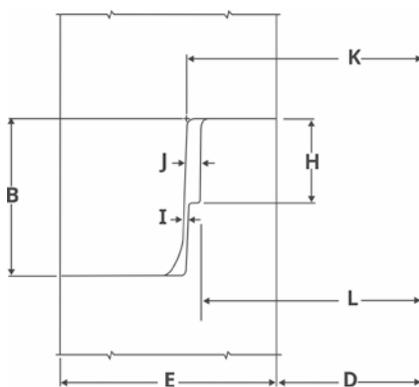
Geometría de las juntas de tuberías para diámetros mayores a 1200 mm
